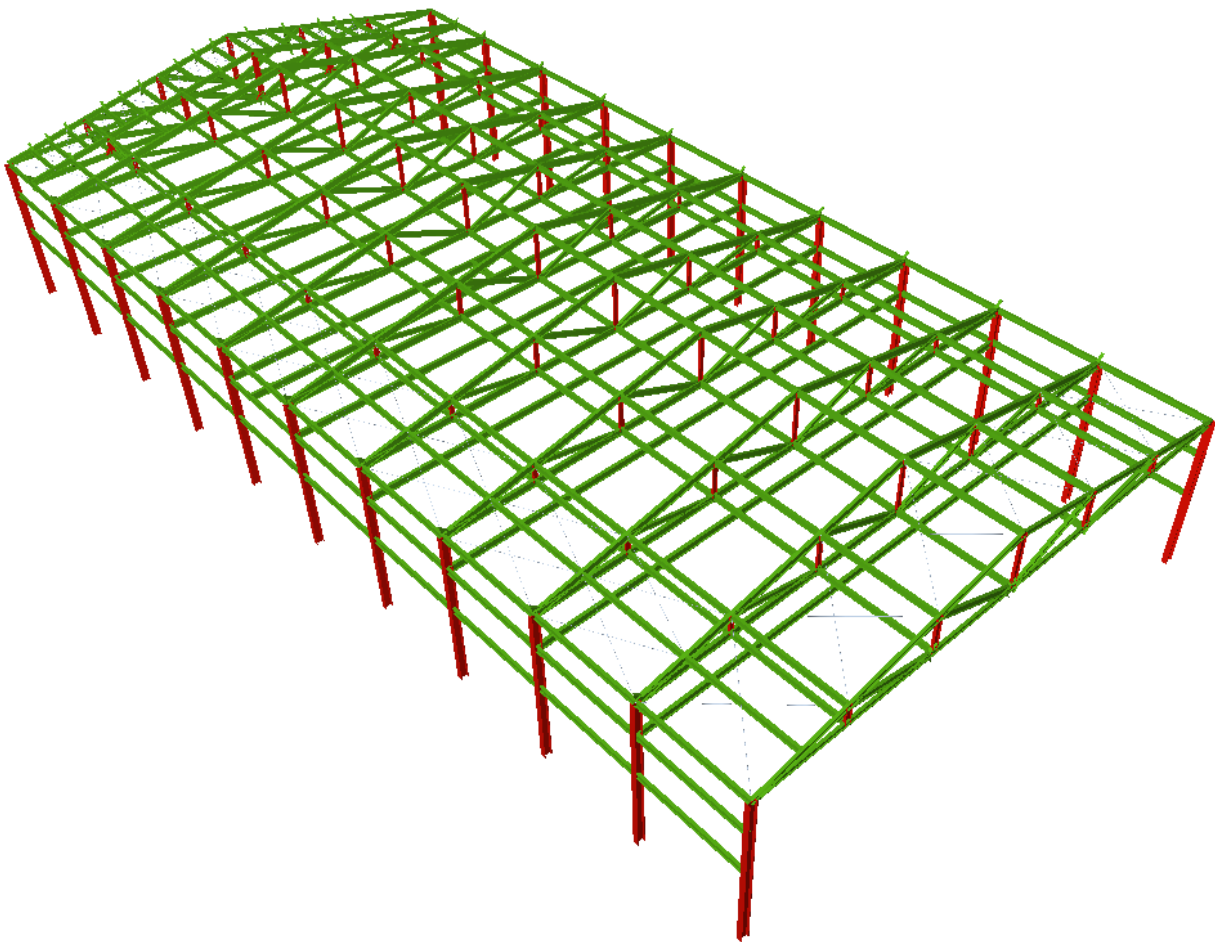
Vista tridimensional de la estructura de la nave industrial
